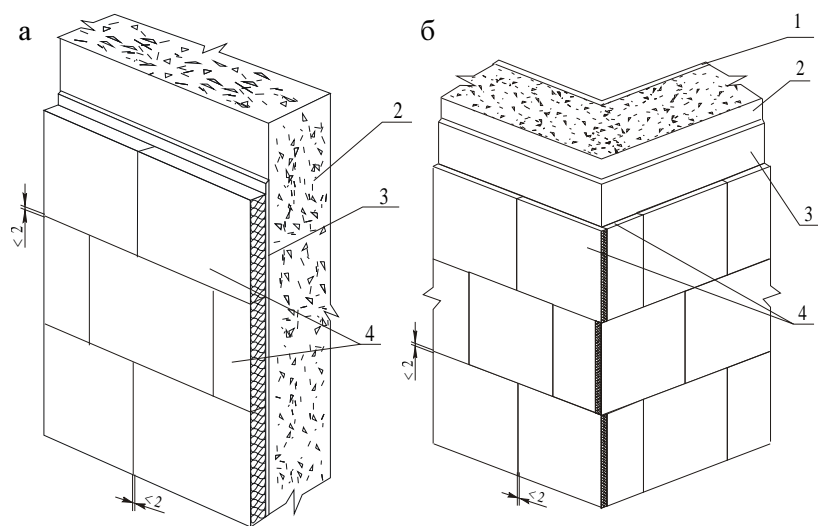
Схемы расположения плит утеплителя на поверхности наружных конструкций.
